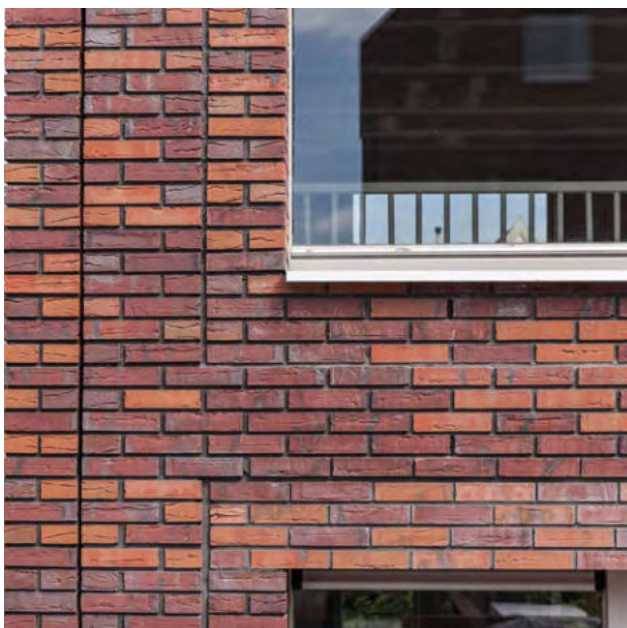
Beispiel Ziegelmauerwerk - Roter Fassadenton mit Verwendung von zwei unterschiedlichen Ziegelfarben.
